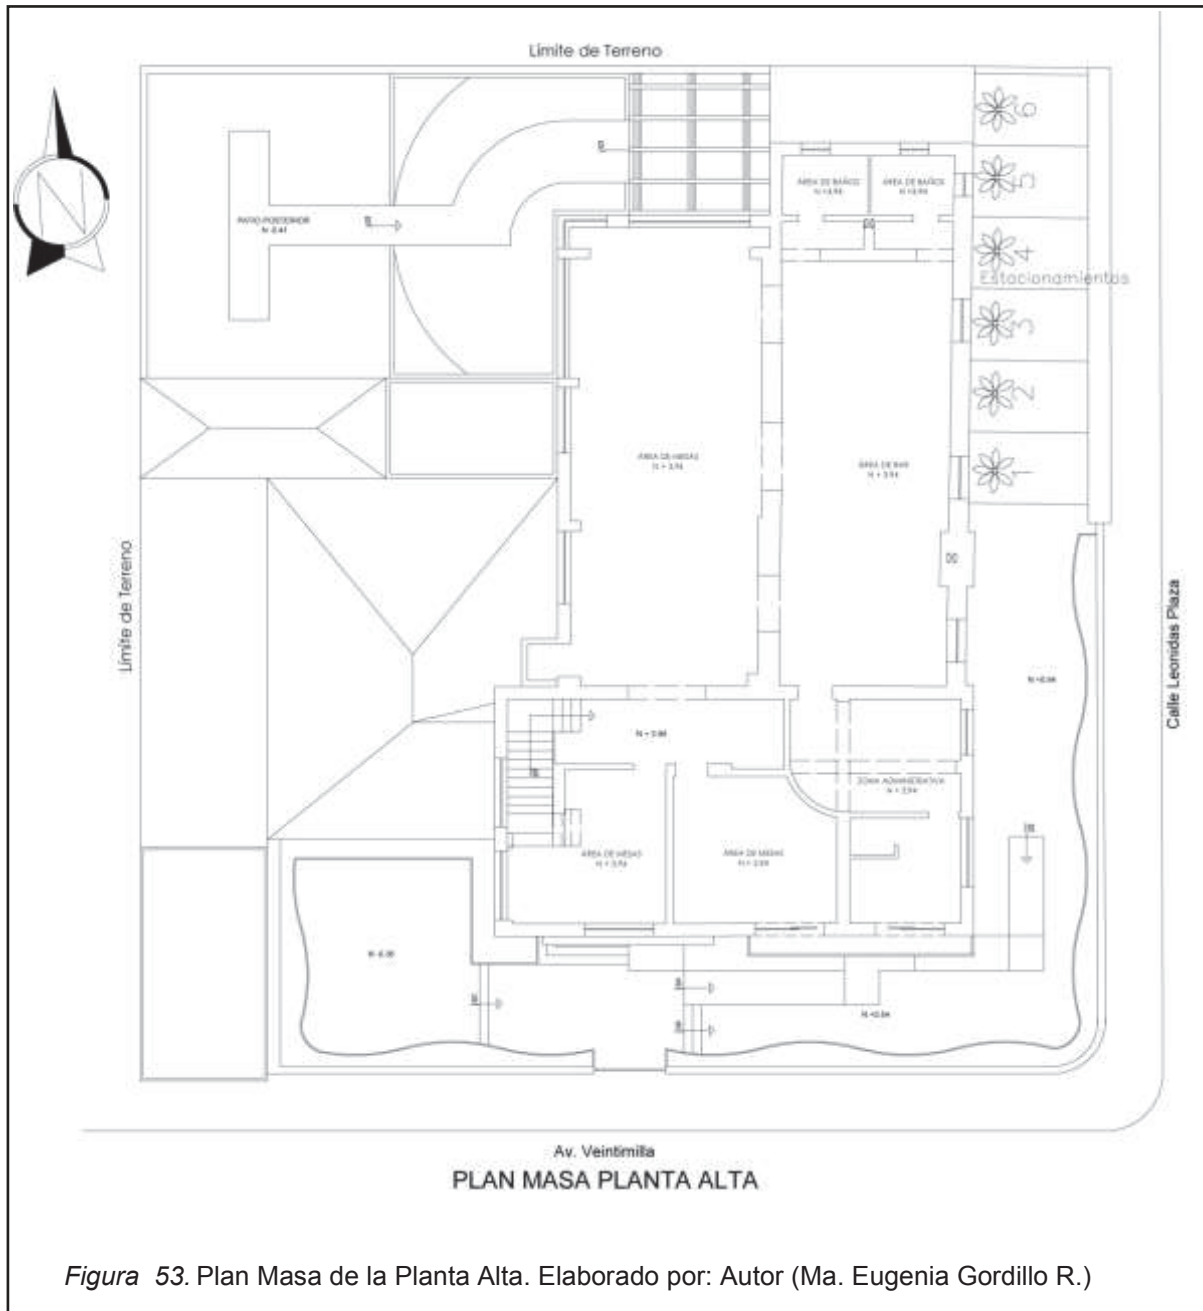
Plan Masa de la Planta Alta. Elaborado por: Autor (Ma. Eugenia Gordillo R.)
